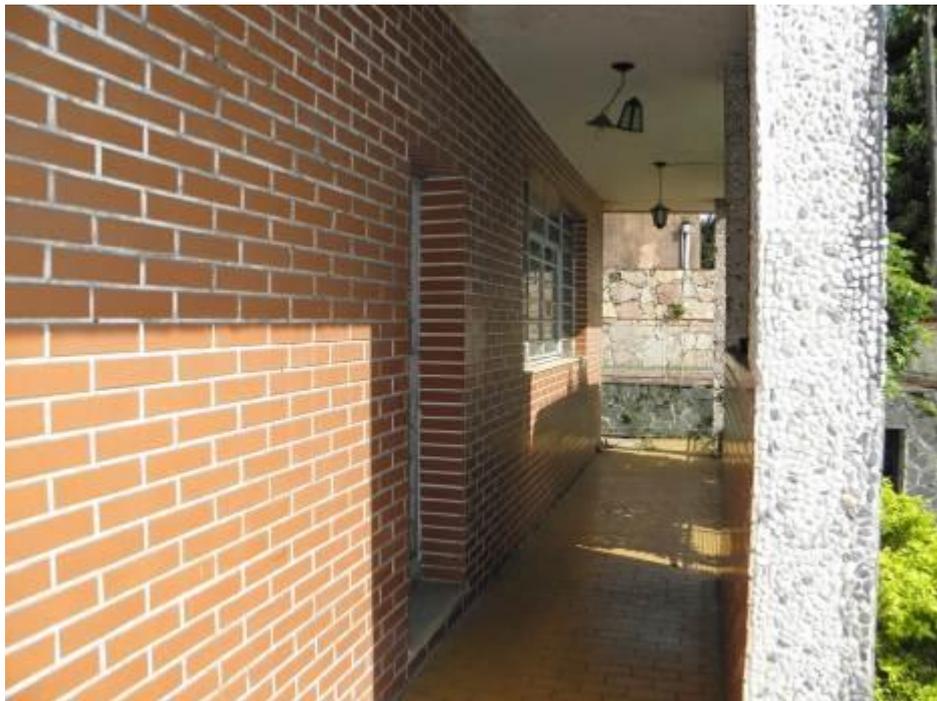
Vista geral da casa no lote 6 e parte do lote 7
